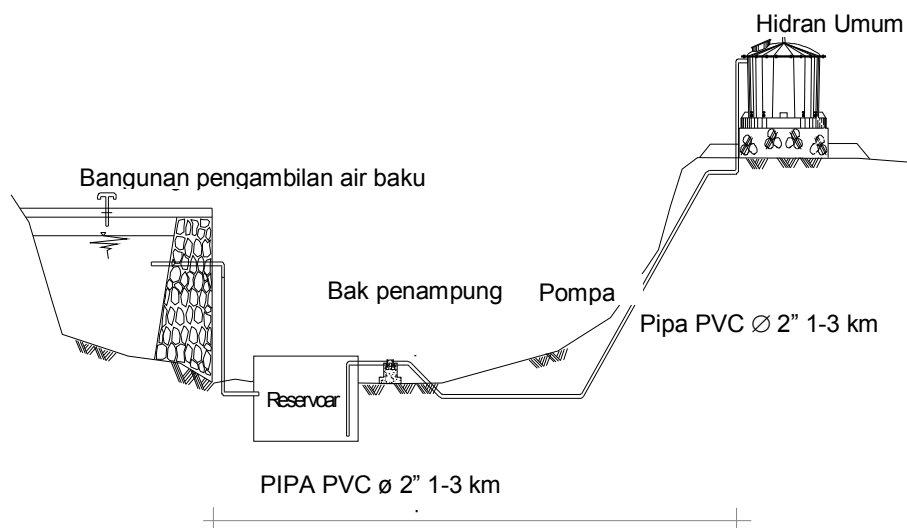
Potongan 2 bangunan pengambilan sumuran
